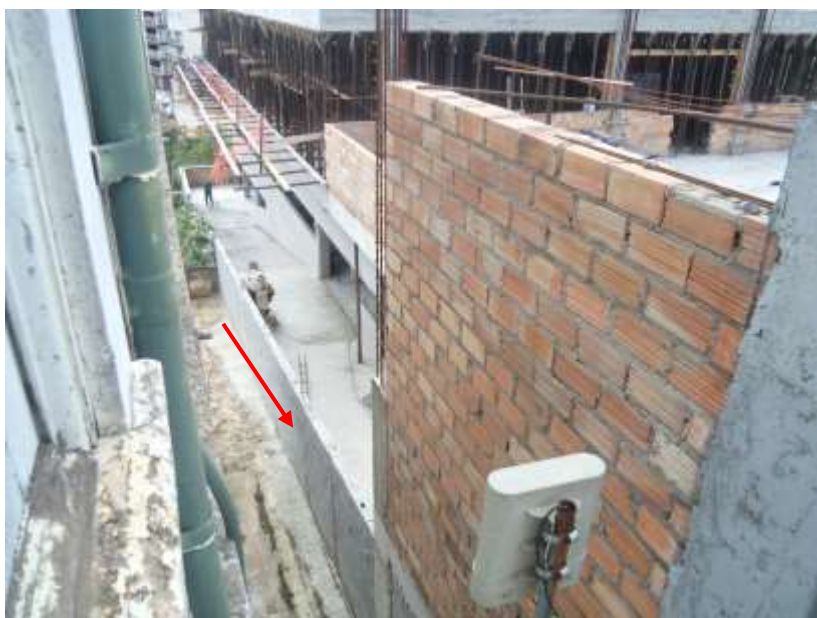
A seta mostra o muro de blocos de concreto com armação executado na divisa dos imóveis.
